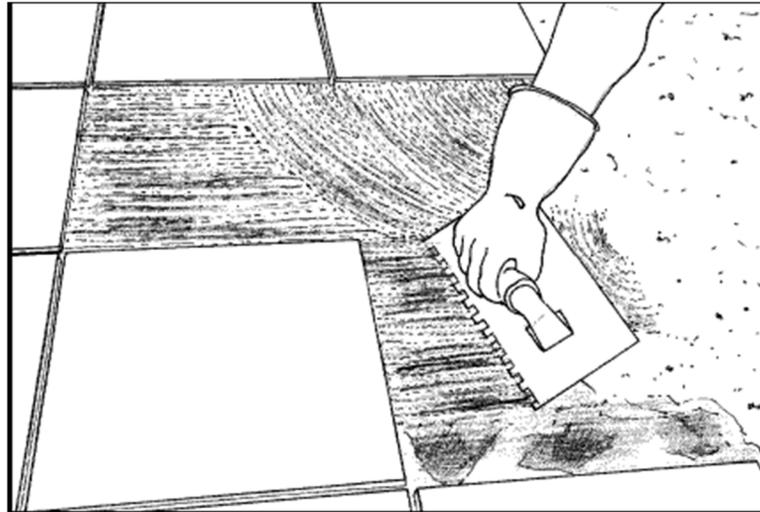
Revestimento pavimentos cerâmicos (Fonte: <http://construcaociviltips.blogspot.pt>)
